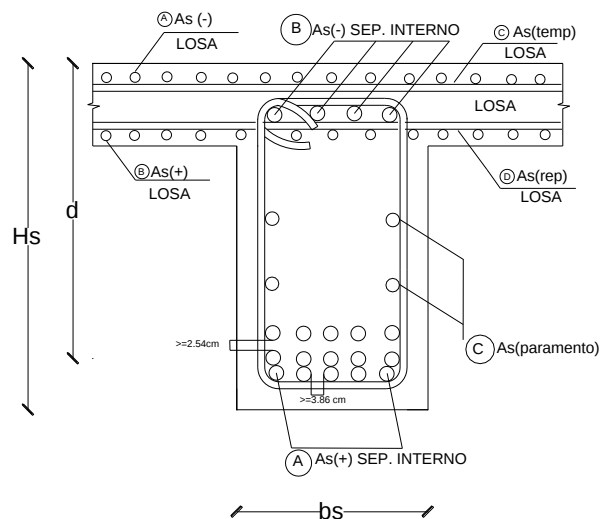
Sección Transversal del Separador Interno. Posición de los aceros del Separador y de la losa.
